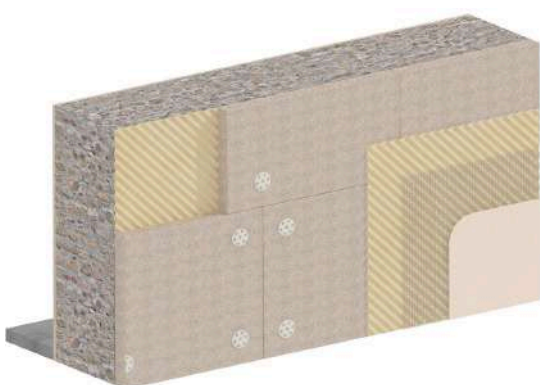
Muratura in pietra con pannelli in fibra di canapa
